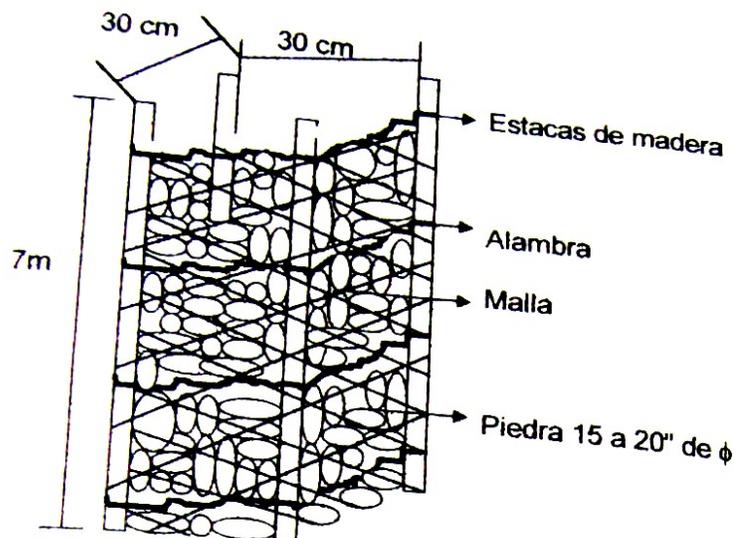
Detalle de la construcción del filtro para drenaje de gases
